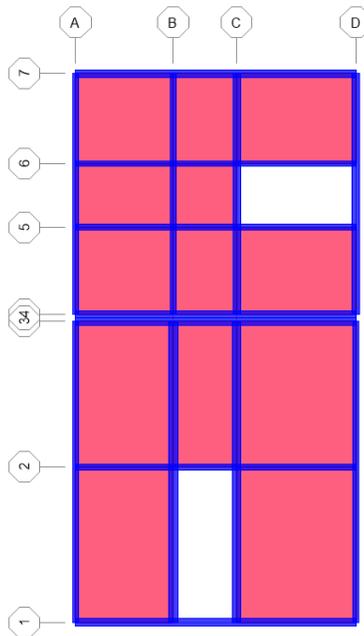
Vista en Planta de modelamiento en el SAP 2000
